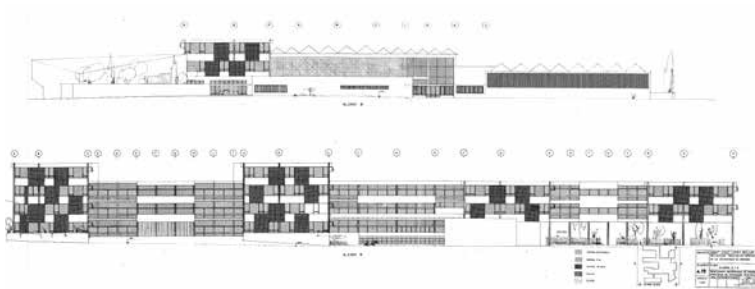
Proyecto original. Alzados O y E del conjunto. Archivo AL-M.
